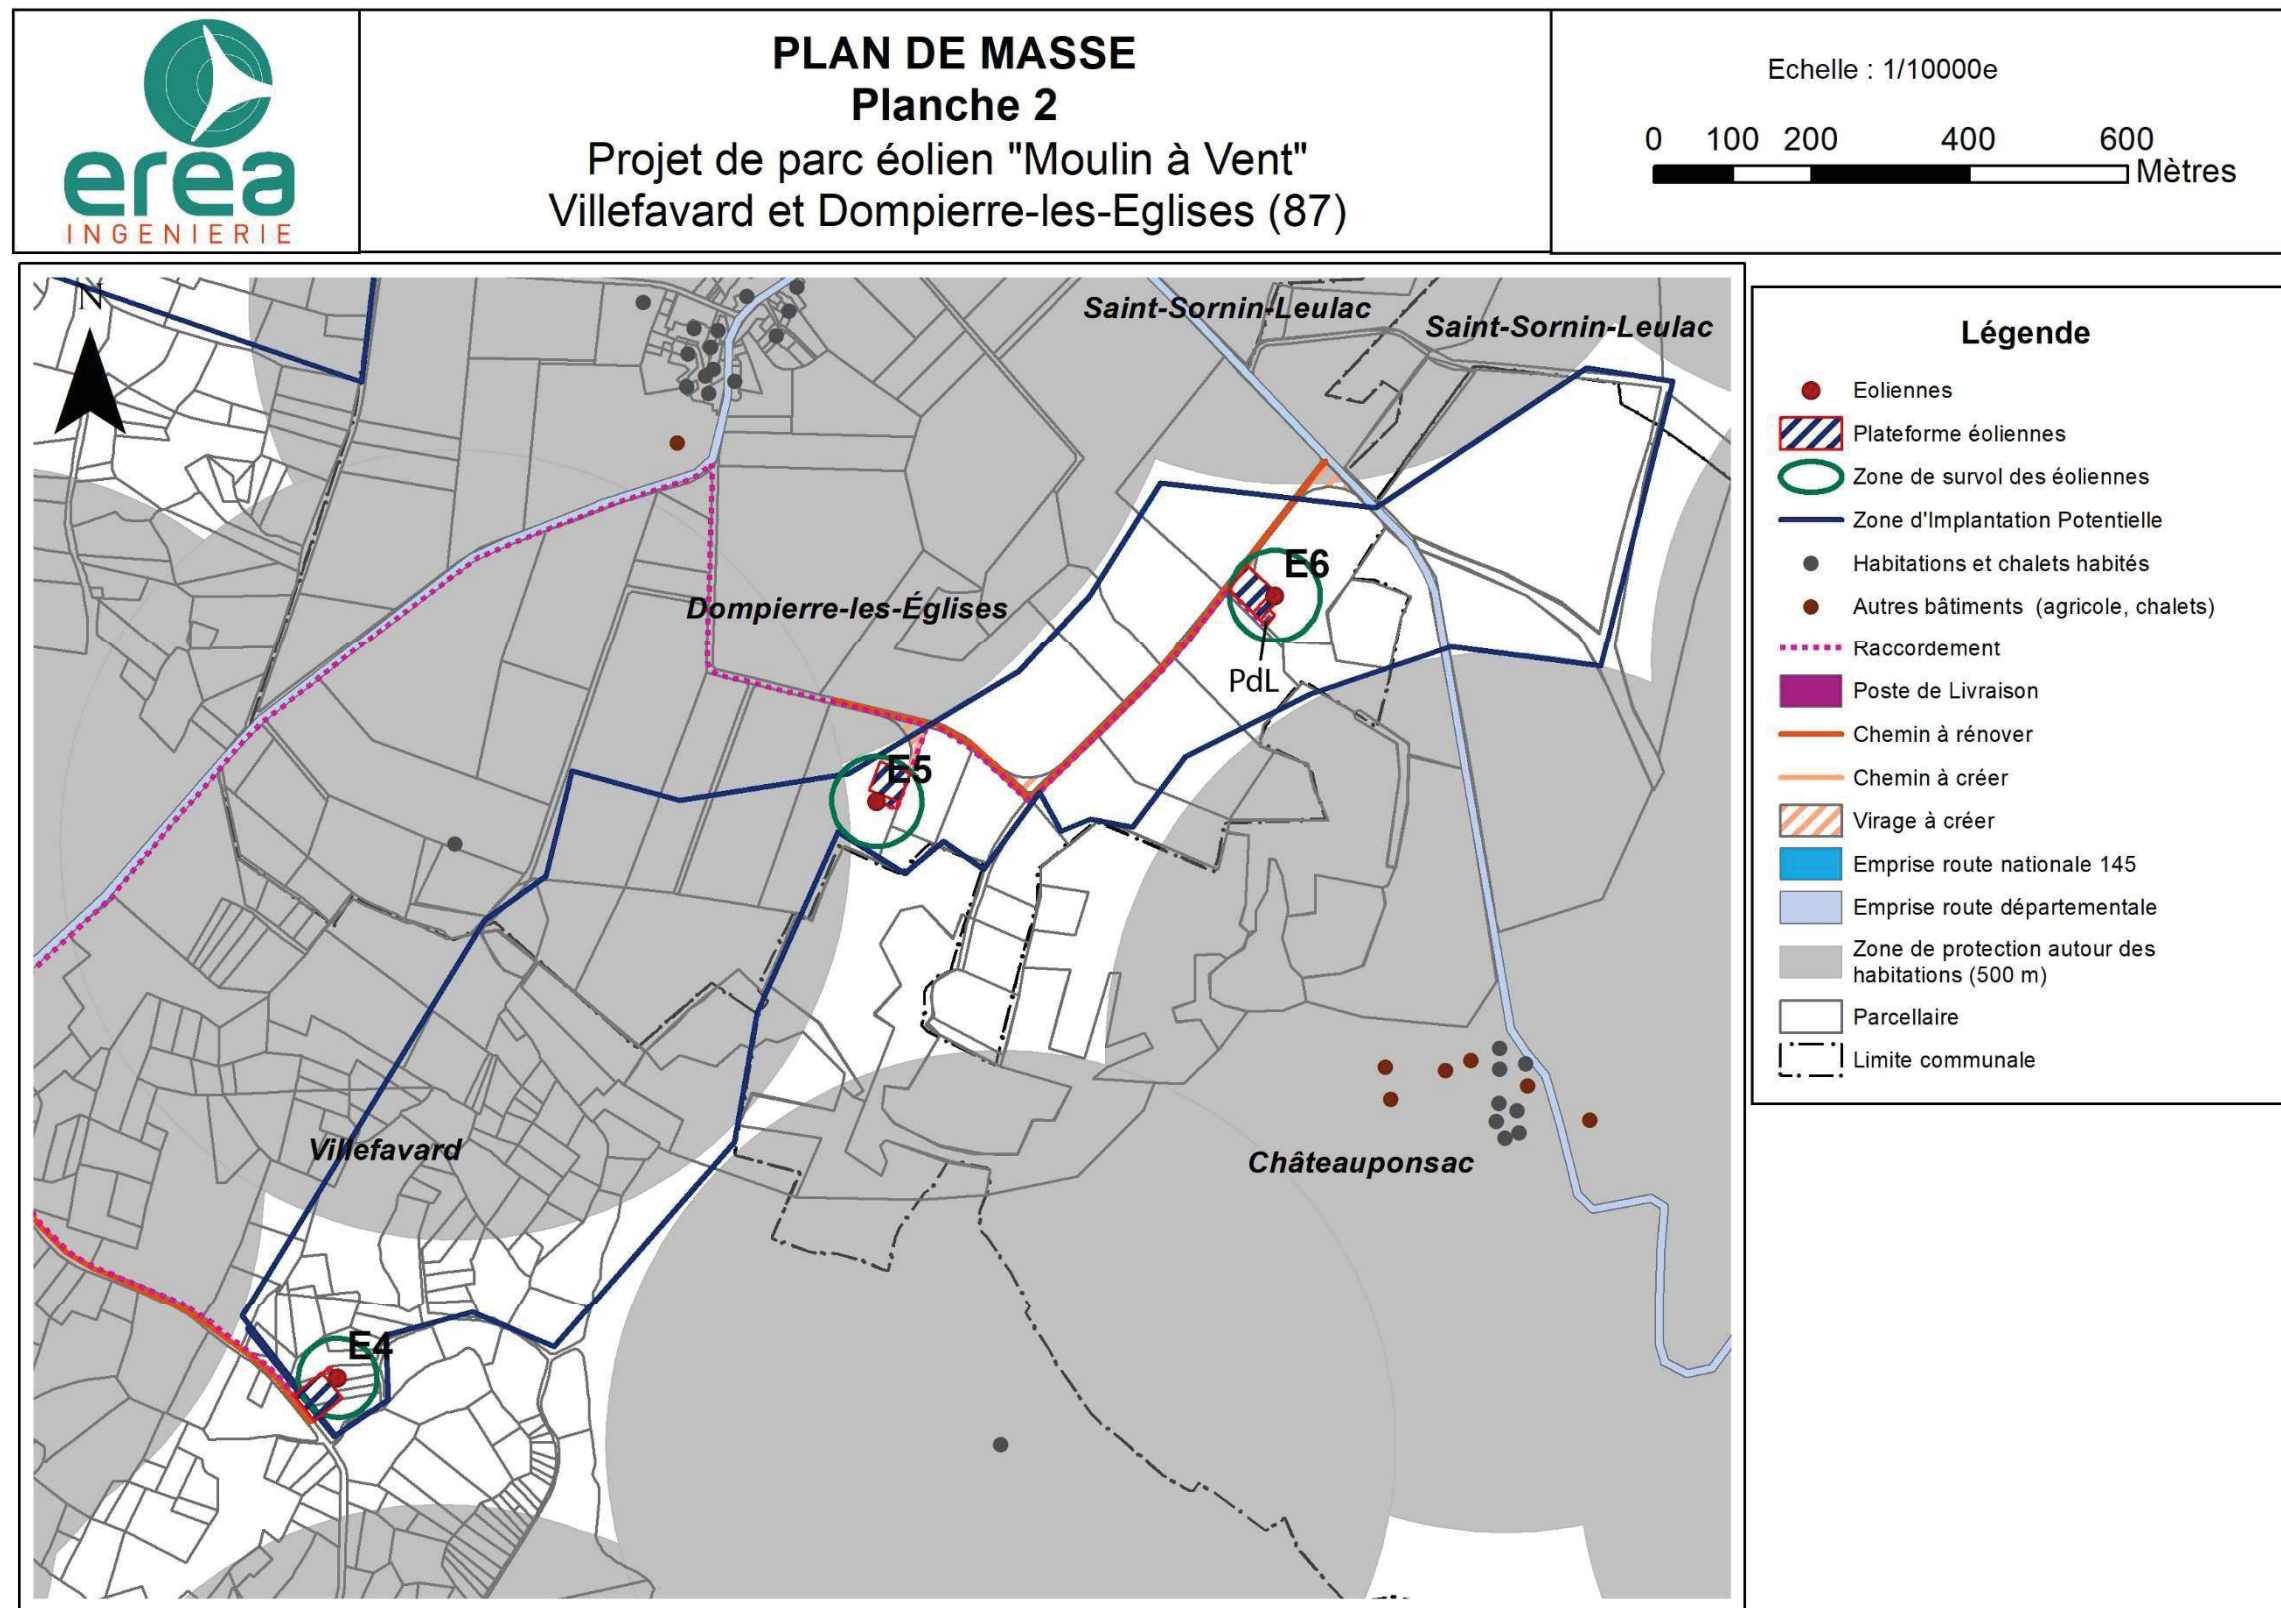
Plan de masse du projet (zoom sur les éoliennes E4 à E6)
